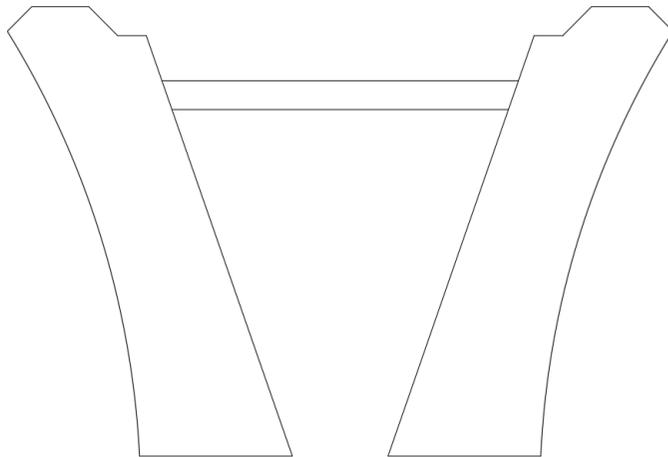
Pila número 3. (Fuente: elaboración propia en AutoCAD).
